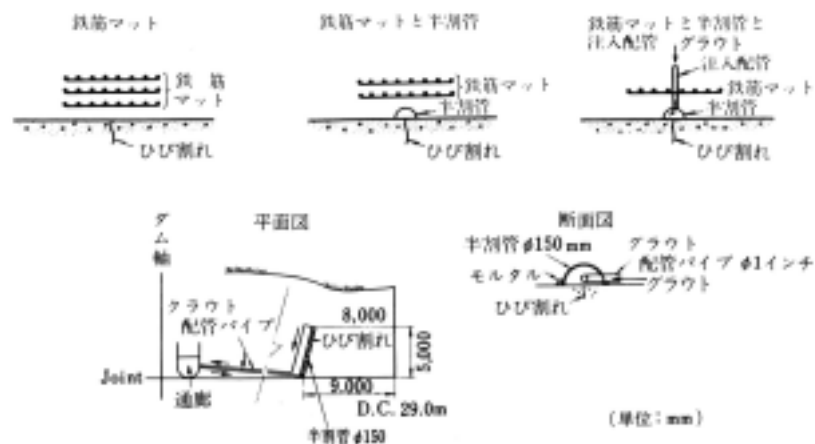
鉄筋による一般的なひび割れの処理
